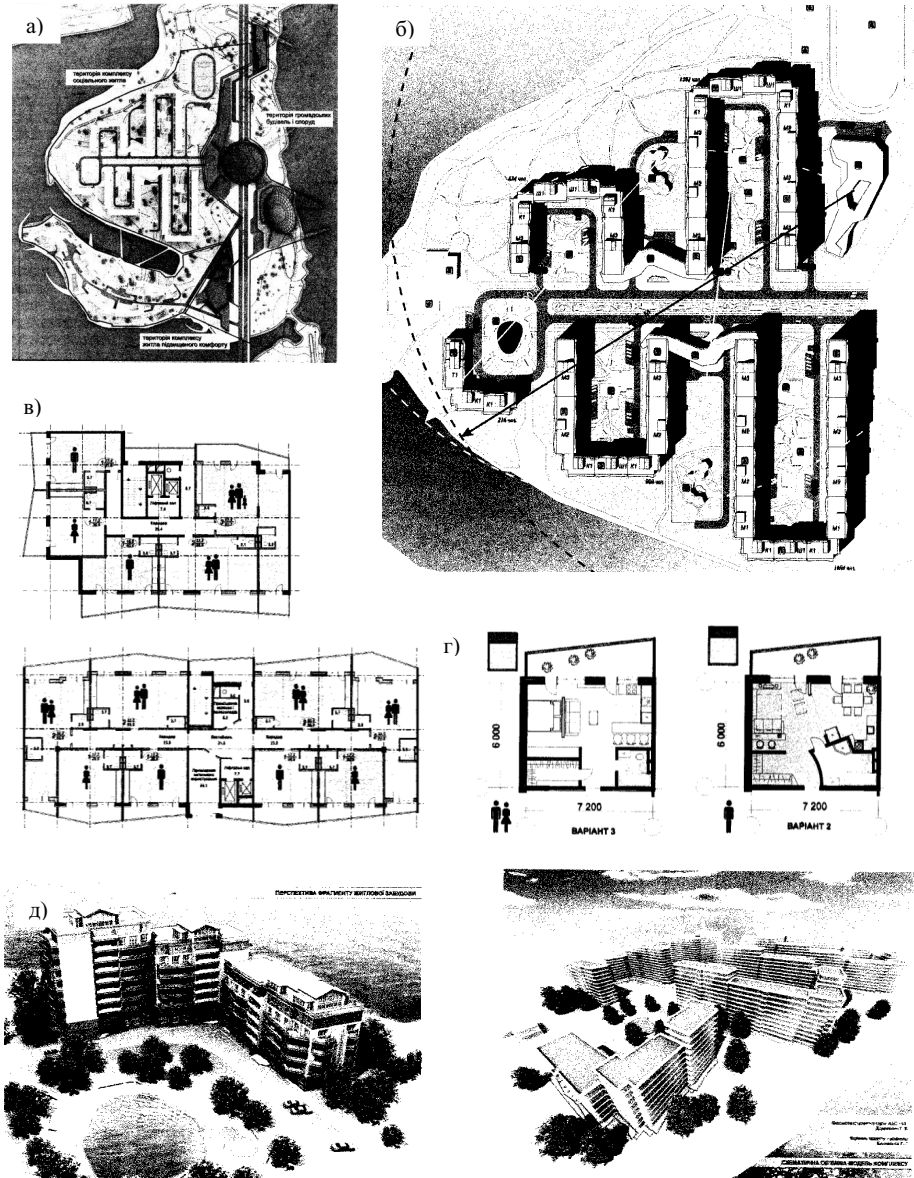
Варіанти планування квартир у комплексах соціального житла з використанням монолітних залізобетонних конструкцій з широким кроком несучих опор
